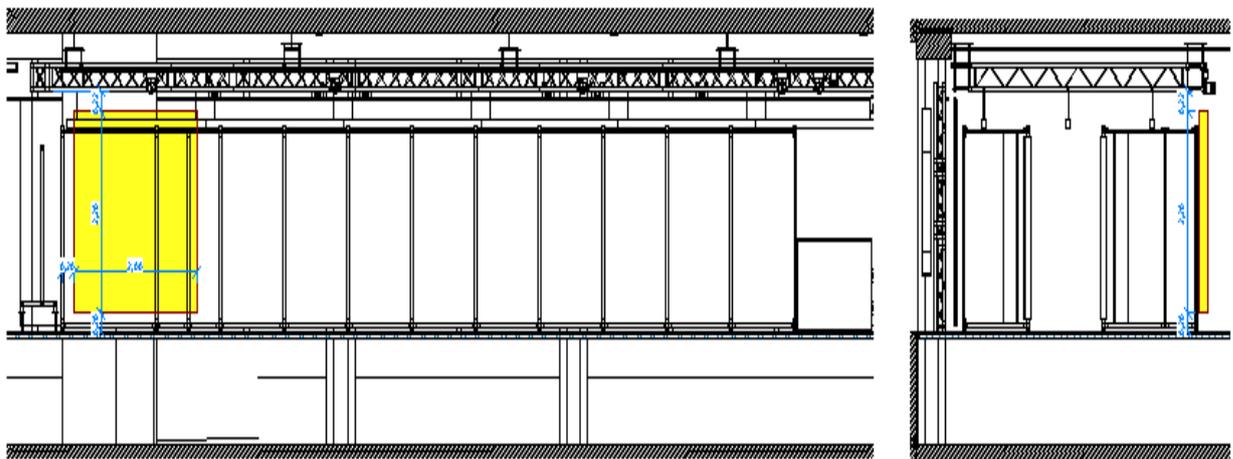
Ejemplo de representación de detalles de estructura Truss incorporados a la plataforma BIM (fuente: propia).
